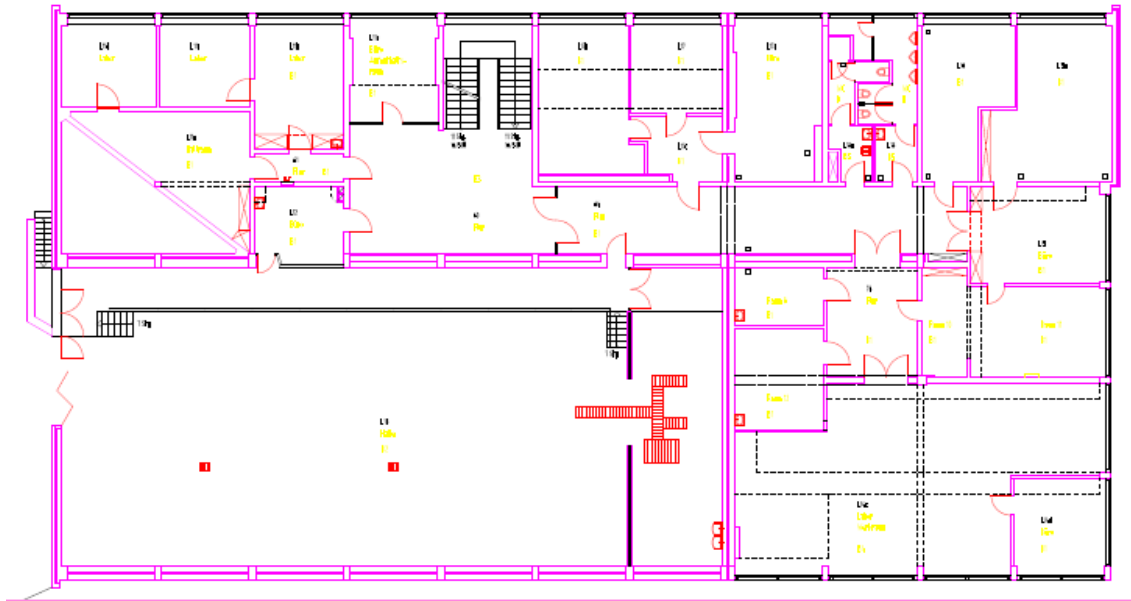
Grundrissplan 1. OG, Gebäude HF
